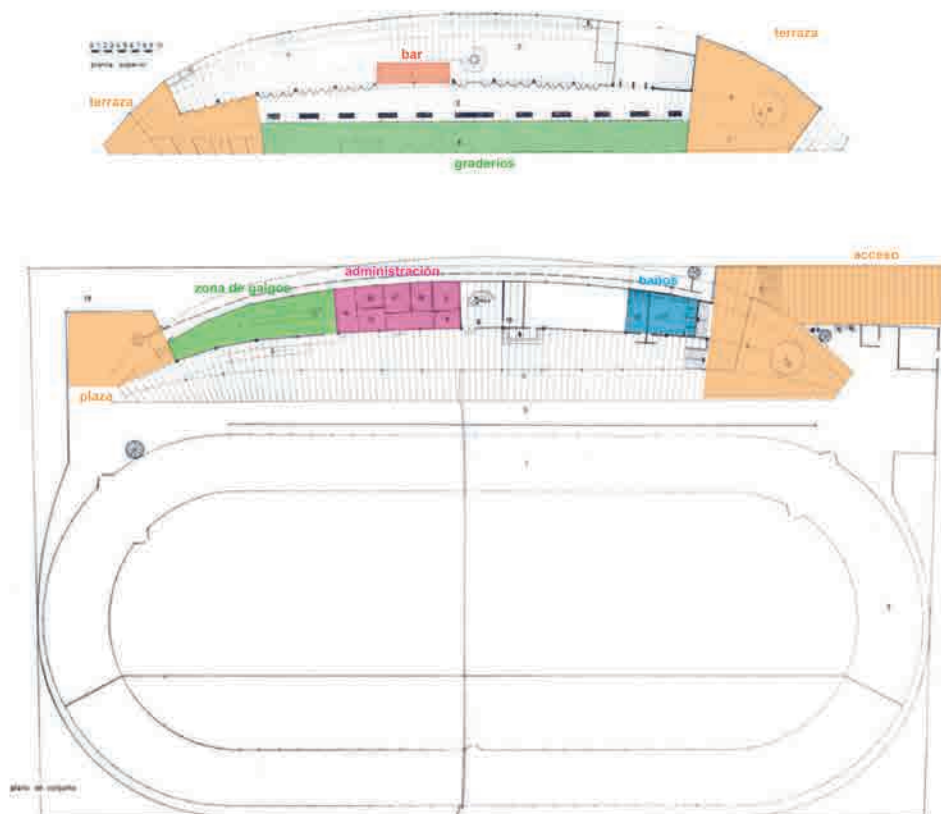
Planta baja y planta alta. Fuente: www.docomomoiberico.com. Elaboración: Autores.
